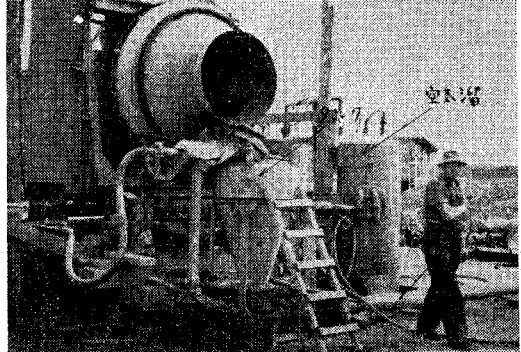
圧縮空気式コンクリートポンプによるコンクリートの施工
